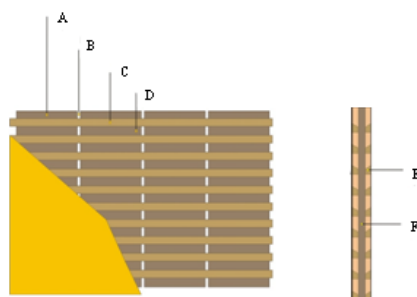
Esquema do sistema estrutural de madeira de uma parede divisória de tabique. Tábua vertical (A – largura, F – espessura, B – afastamento); Ripa horizontal (C – largura, E – espessura, D – afastamento)
